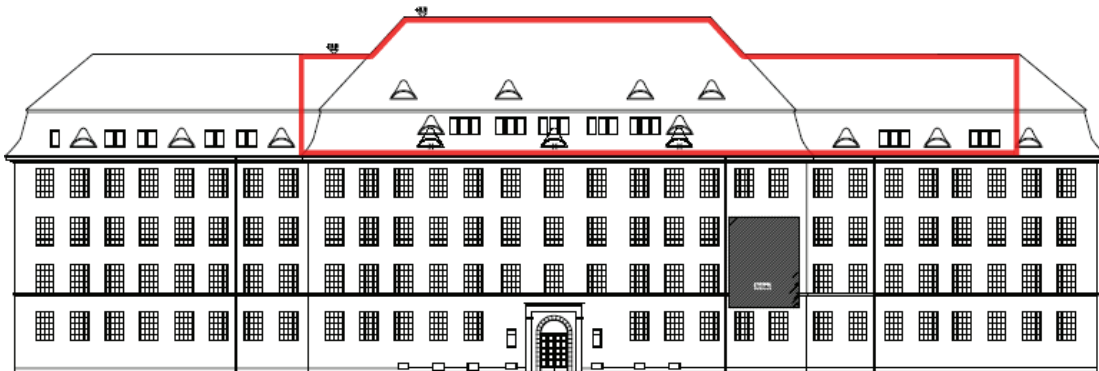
Ansicht Limburger Straße (auf Grundlage der Architektenpläne KDvJ)
